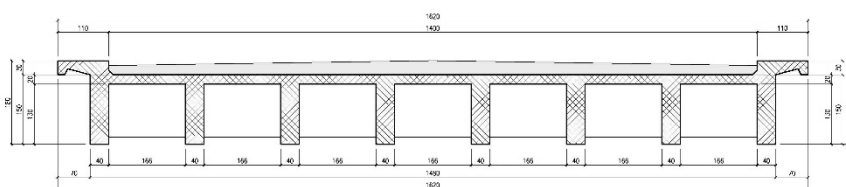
Sezione trasversale Ponte sul Fiume Ronco Stato di Fatto
